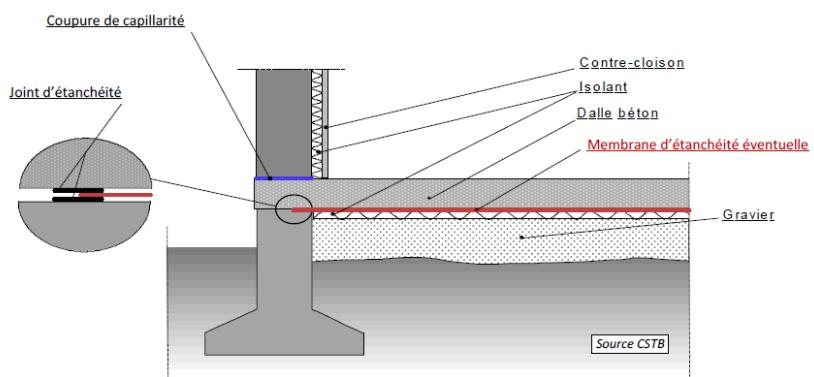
Exemple de conception dans le cas d'une dalle portée sur terre-plein (source : EVALSDS, 2018)
